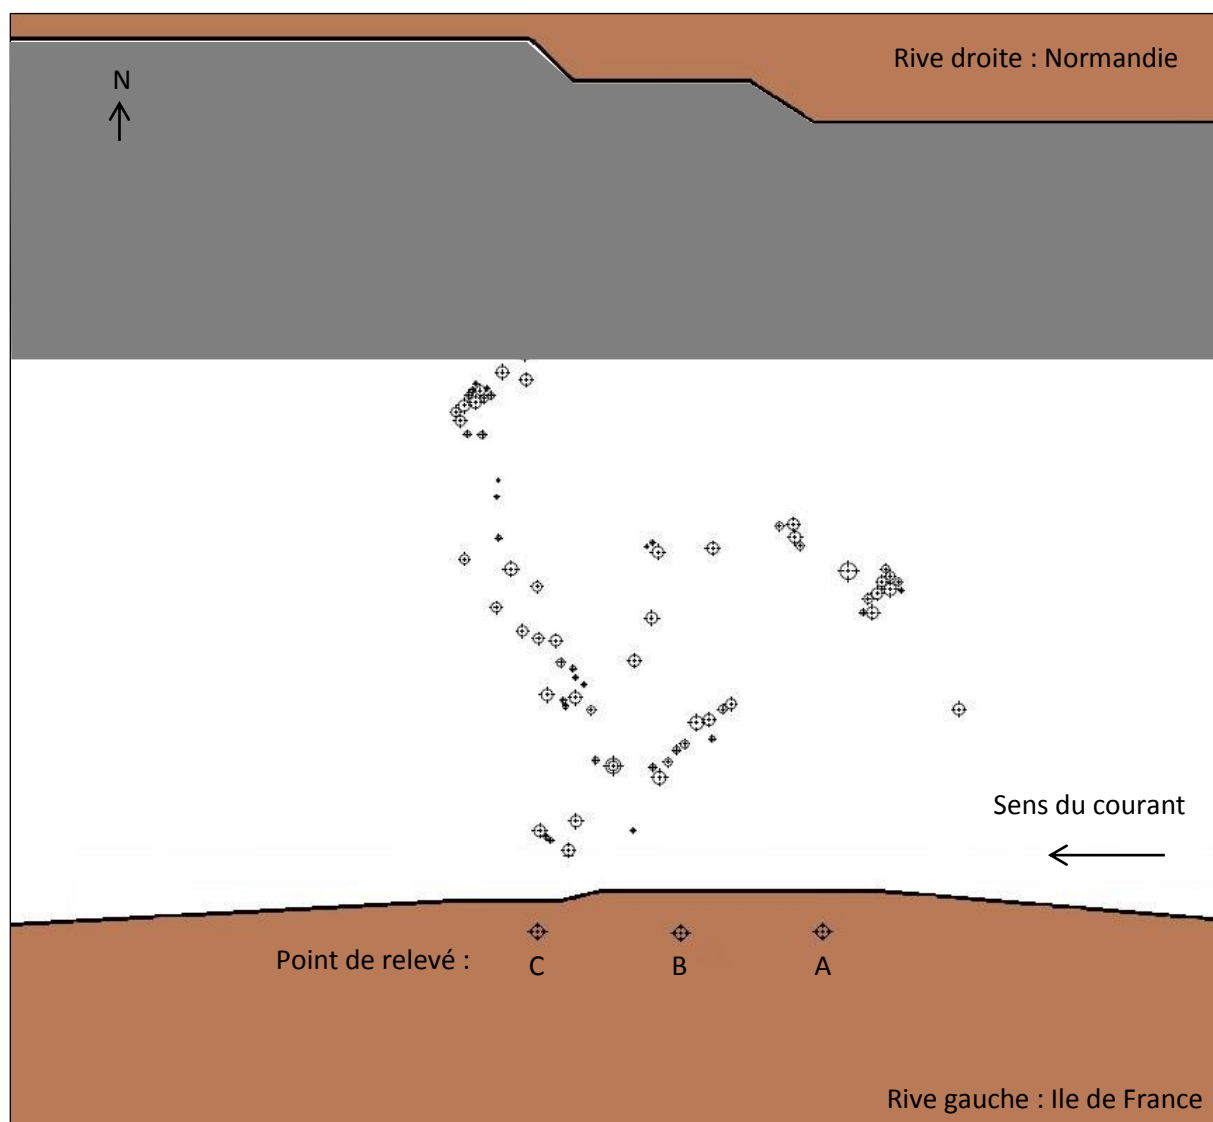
Plan d'ensemble des pieux trouvés en zone 1
